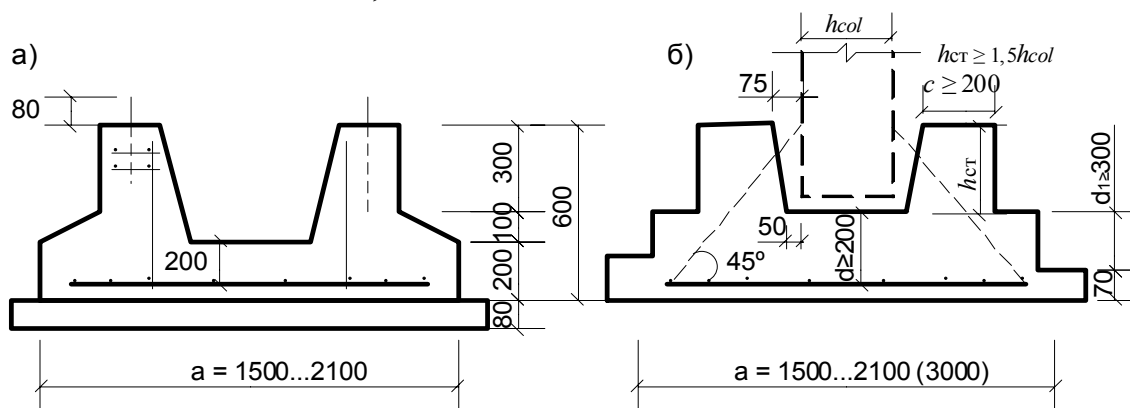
Збірні цільні залізобетонні фундаменти: а – фундамент з похилими ступенями; б – фундамент з прямокутними ступенями
